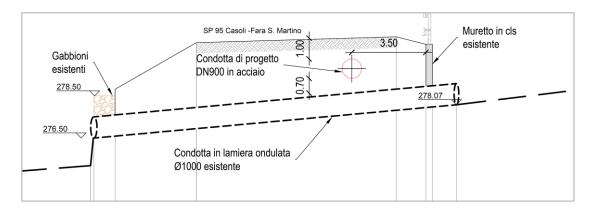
Sezione longitudinale attraversamento di progetto sul Fosso 3.
